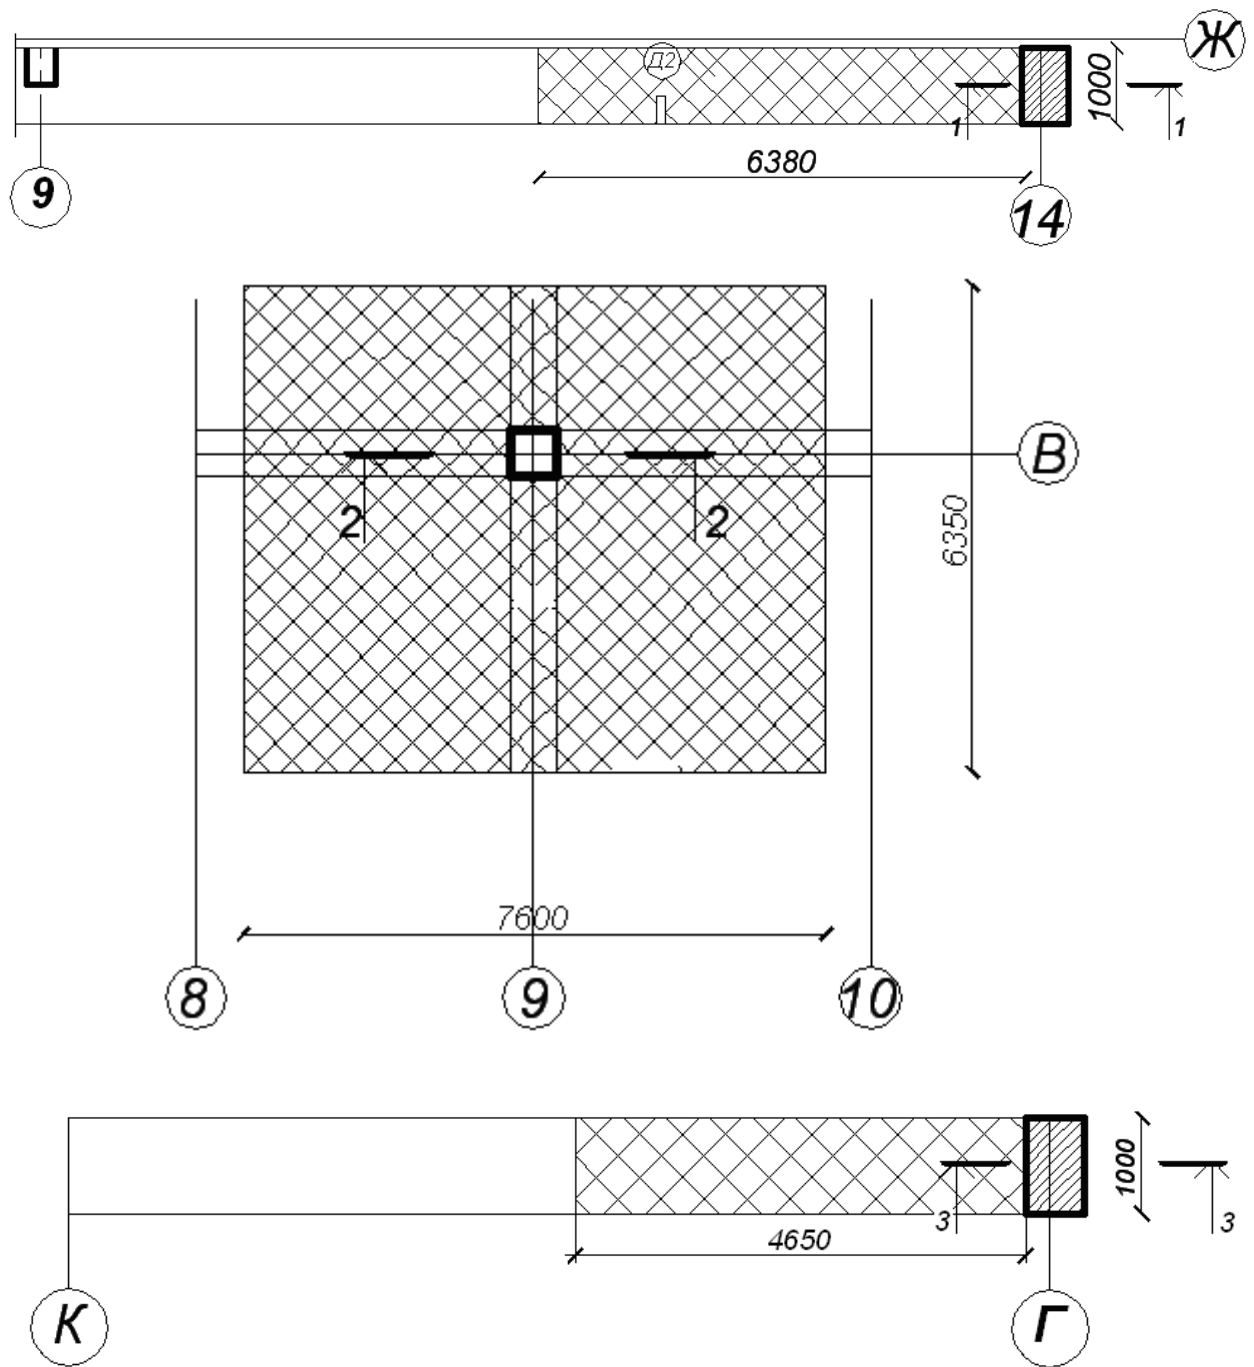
Площа розподілу навантажень на фундамент
